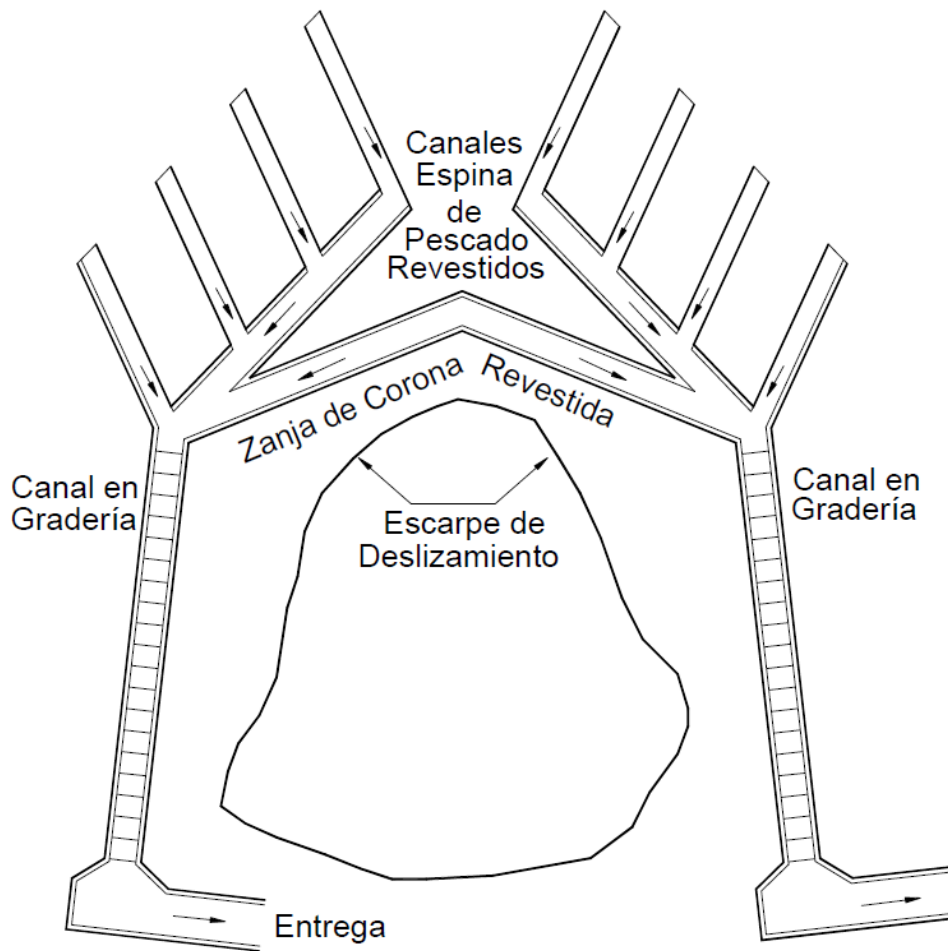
Esquema en planta de canales colectores Espina de Pescado.
